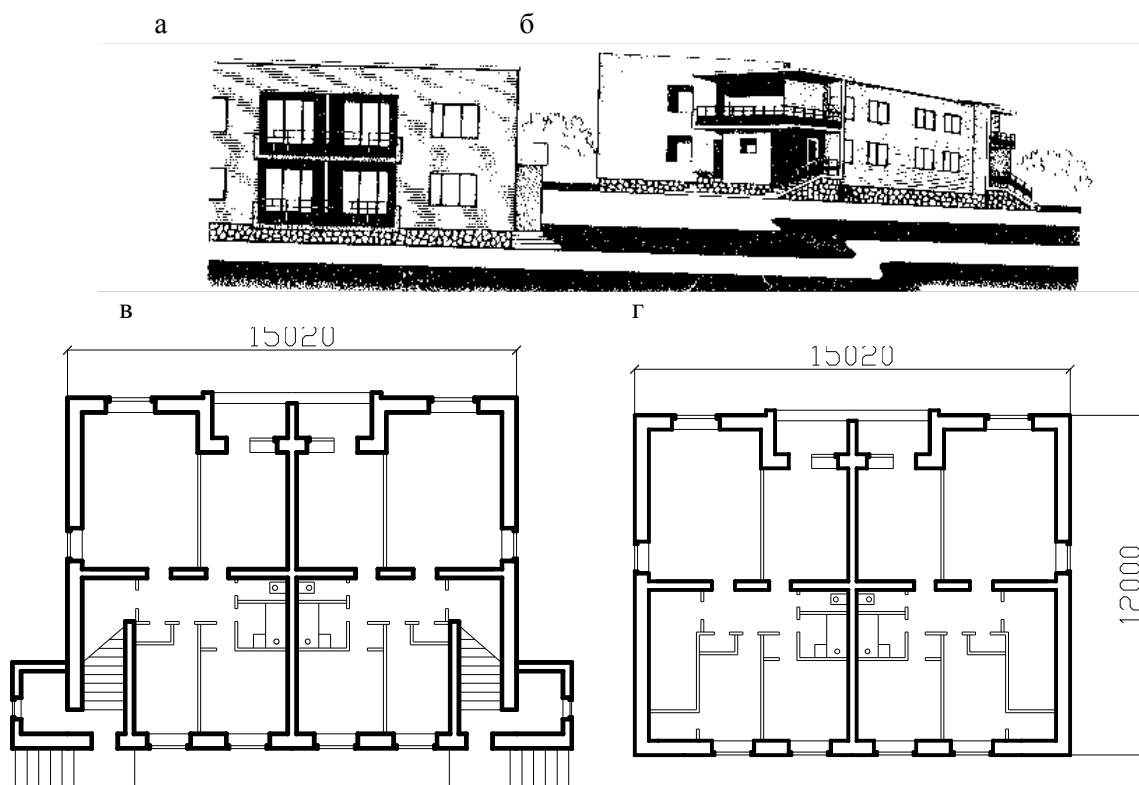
План двухквартирного жилого дома с поэтажным расположением квартир: а – торцовый фасад; б – главный фасад; в – план 1-го этажа; г – план 2-го этажа.
